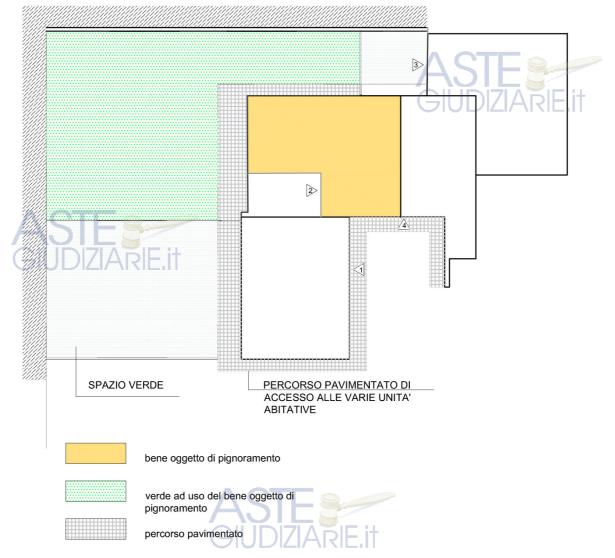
SCHEMA DELLA SUDDIVISIONE ATTUALE SPAZI ESTERNI
